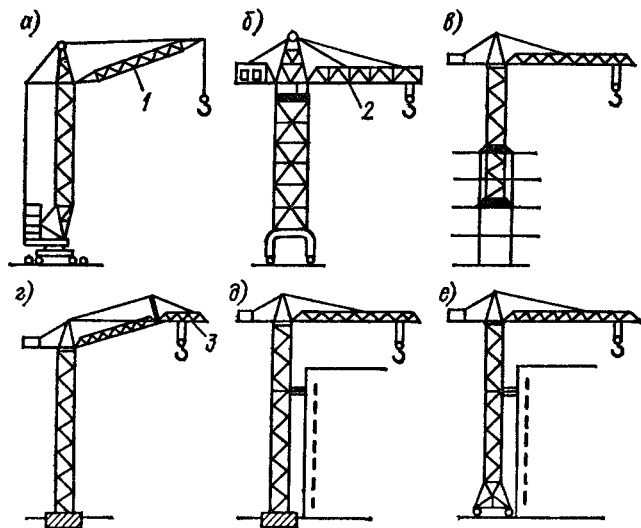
Краны: а — передвижной строительный; б — передвижной судостроительный; в — самоподъемный; г — стационарный; д — приставной; е — универсальный
